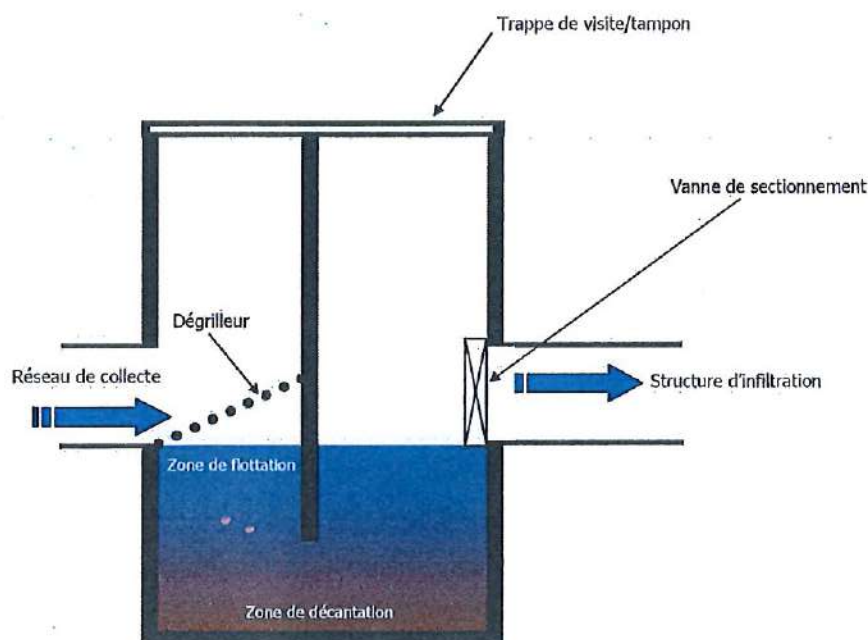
coupe de principe d'une cloison siphonée en amont d'un ouvrage d'infiltration
